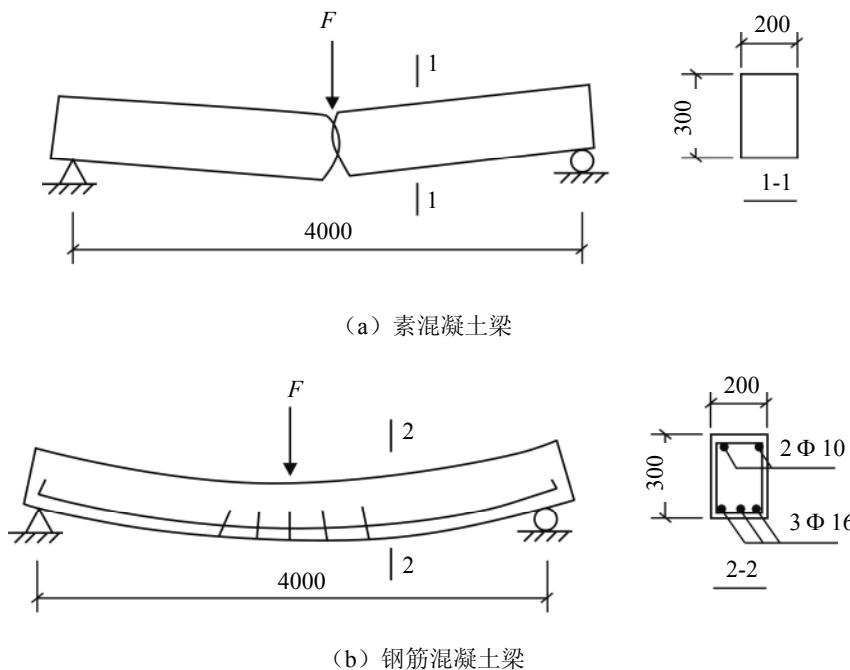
素混凝土梁与钢筋混凝土梁的破坏情况比较
